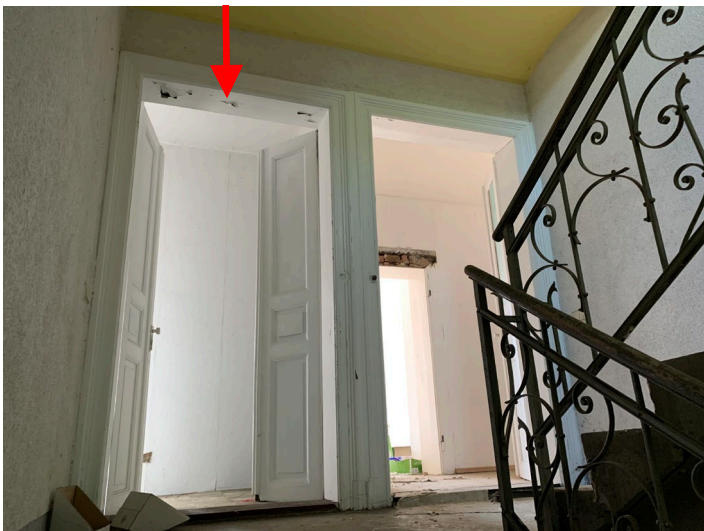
Ansicht Eingang zu Wohnung WE 4
